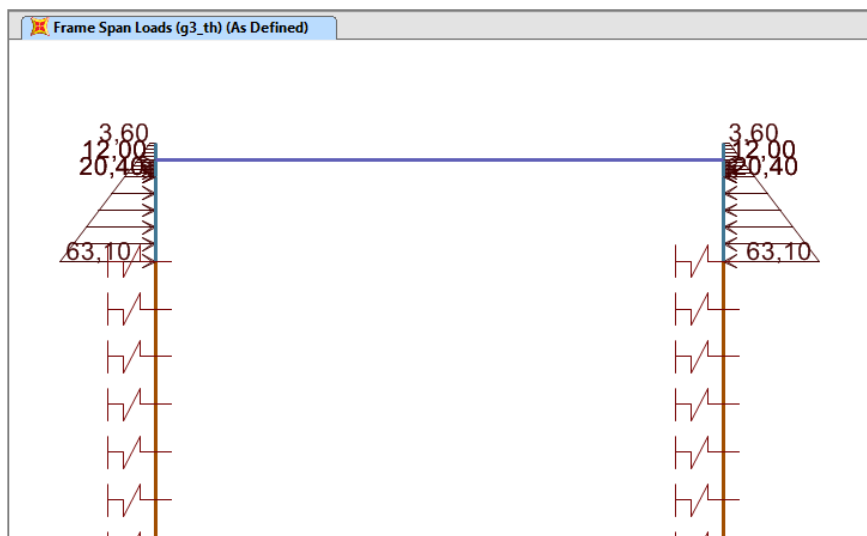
Spinta delle terre sulle spalle.
